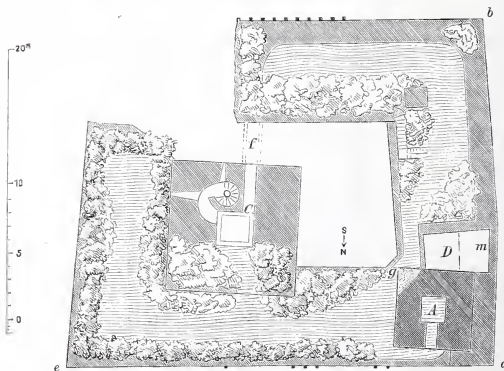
Grundriss der Wehrplatte und des Dachbodens.
